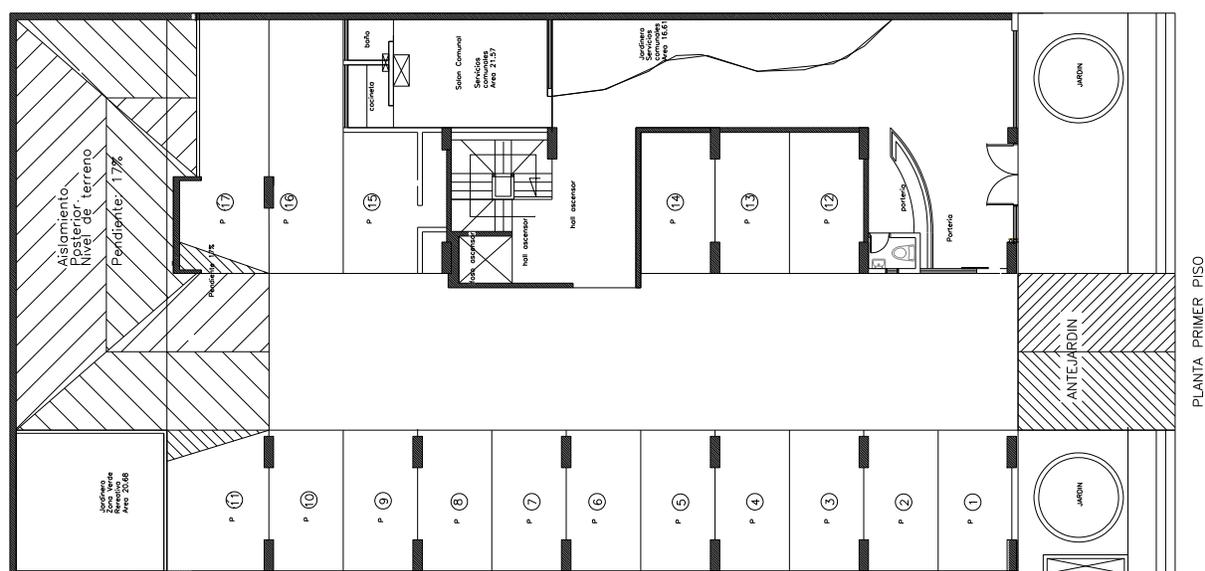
, Planta primer piso, edificio avanti, proyecto personal, 2017.
